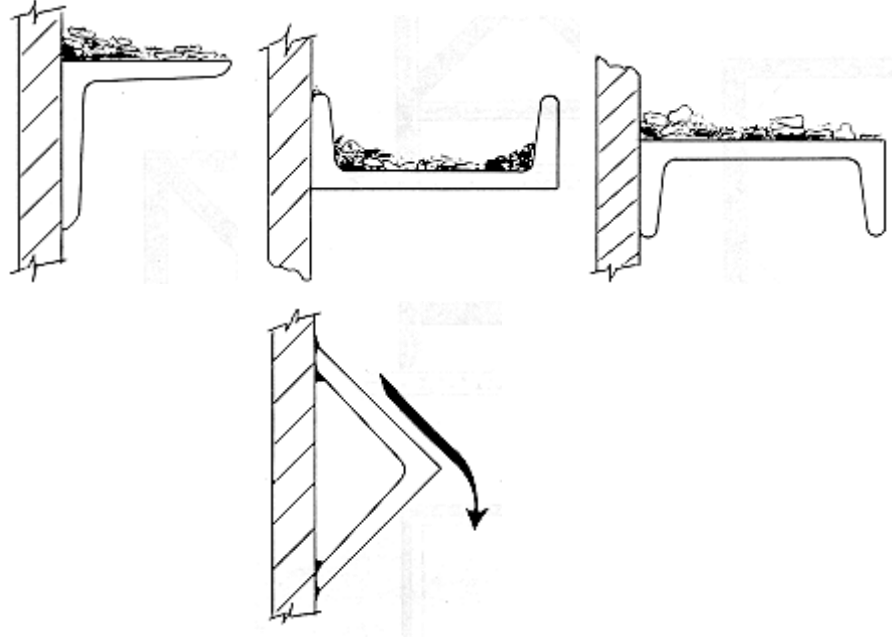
Bazı konstrüksiyon şekilleri
